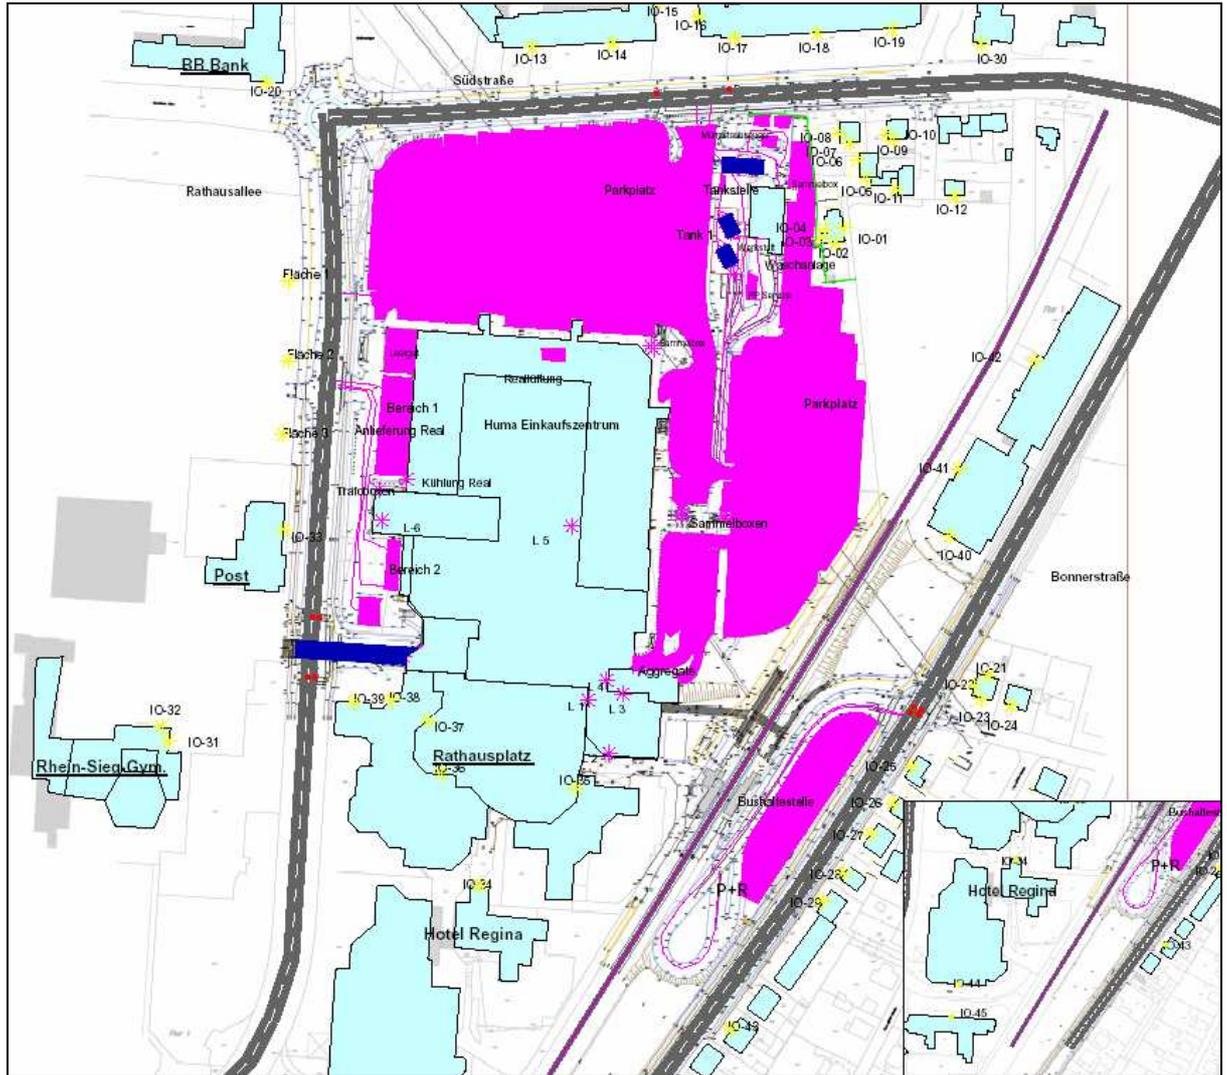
Lageplan Ist-Zustand / Nullfall 2025 / Planfall 0
